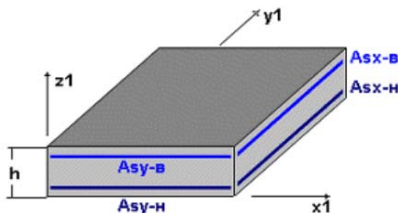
Схема расположения продольной арматуры плит и оболочек.
